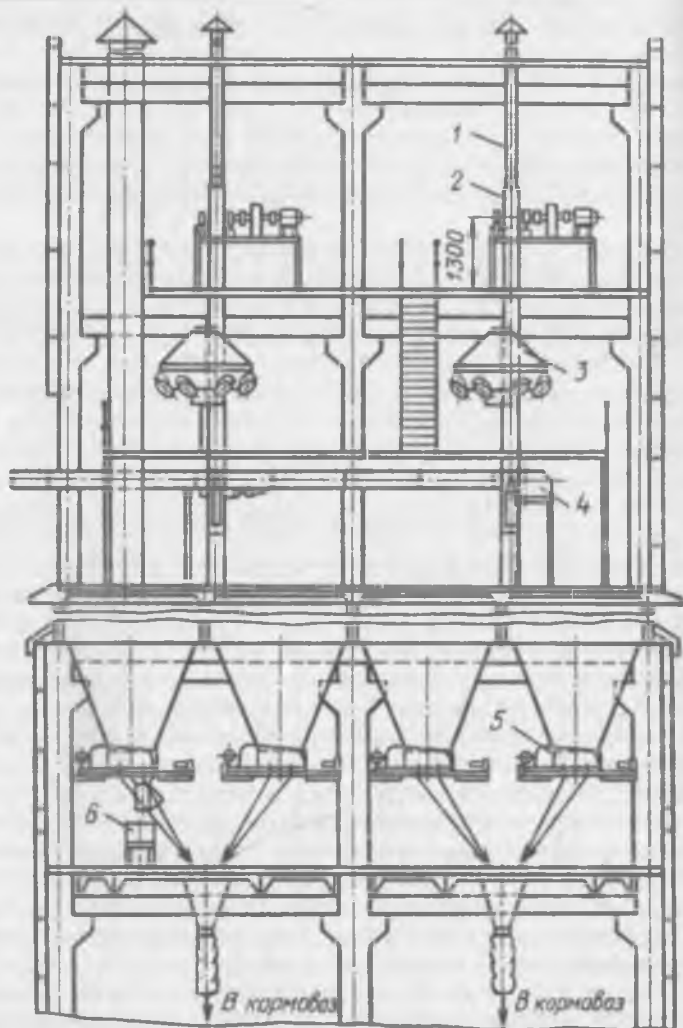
Разрез силосного корпуса готовой продукции с загрузкой автомобилей непосредственно из силосов:
